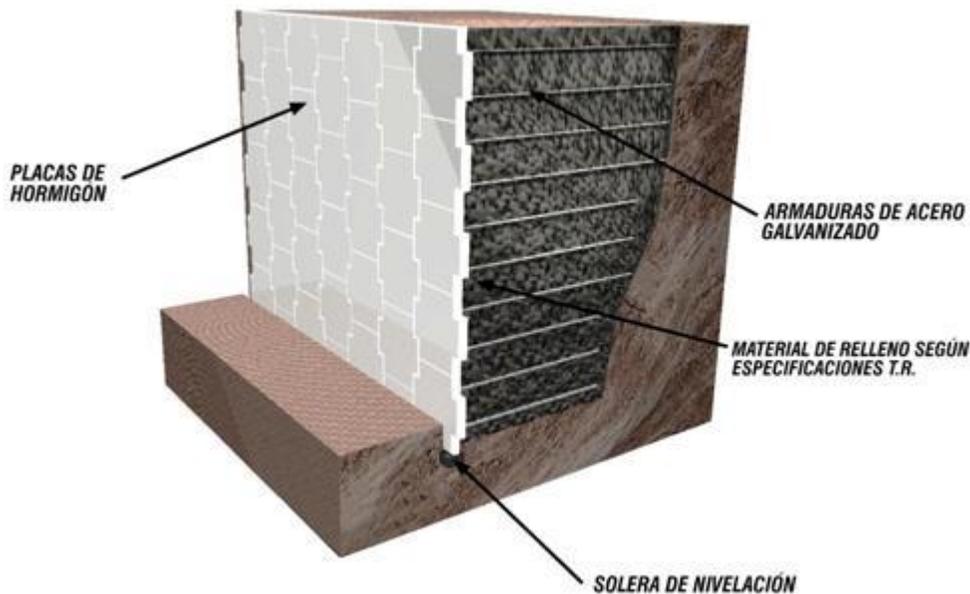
Detalle de elementos del sistema de contención²²
